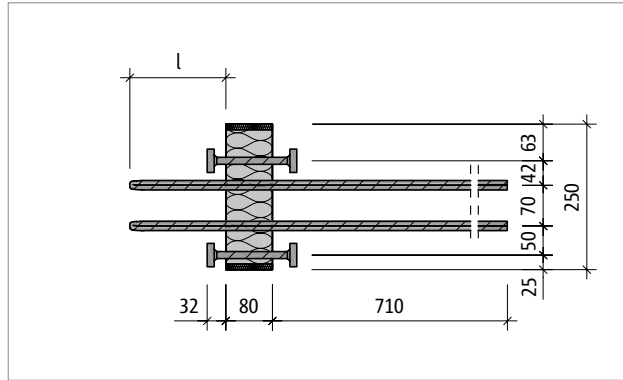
Schöck Isokorb® T Typ OP: Produktgrundriss
